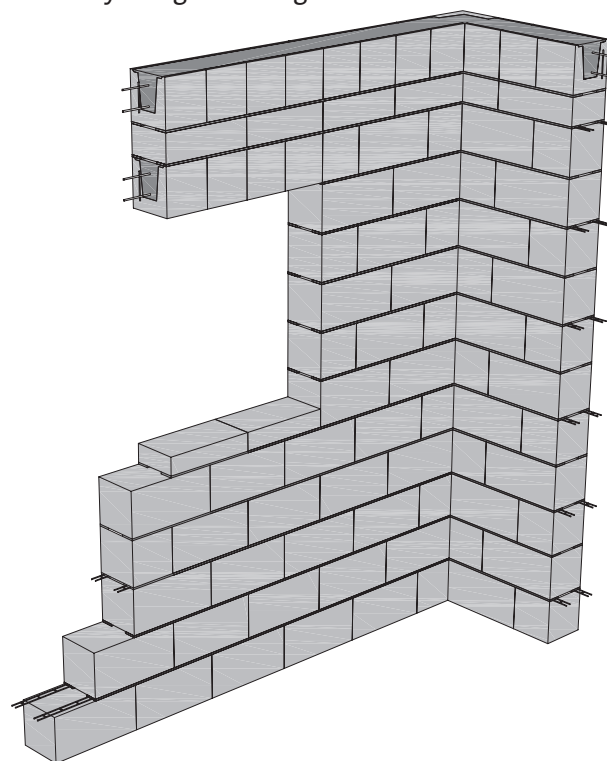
Pilaster av Leca Konstruksjonsblokk
